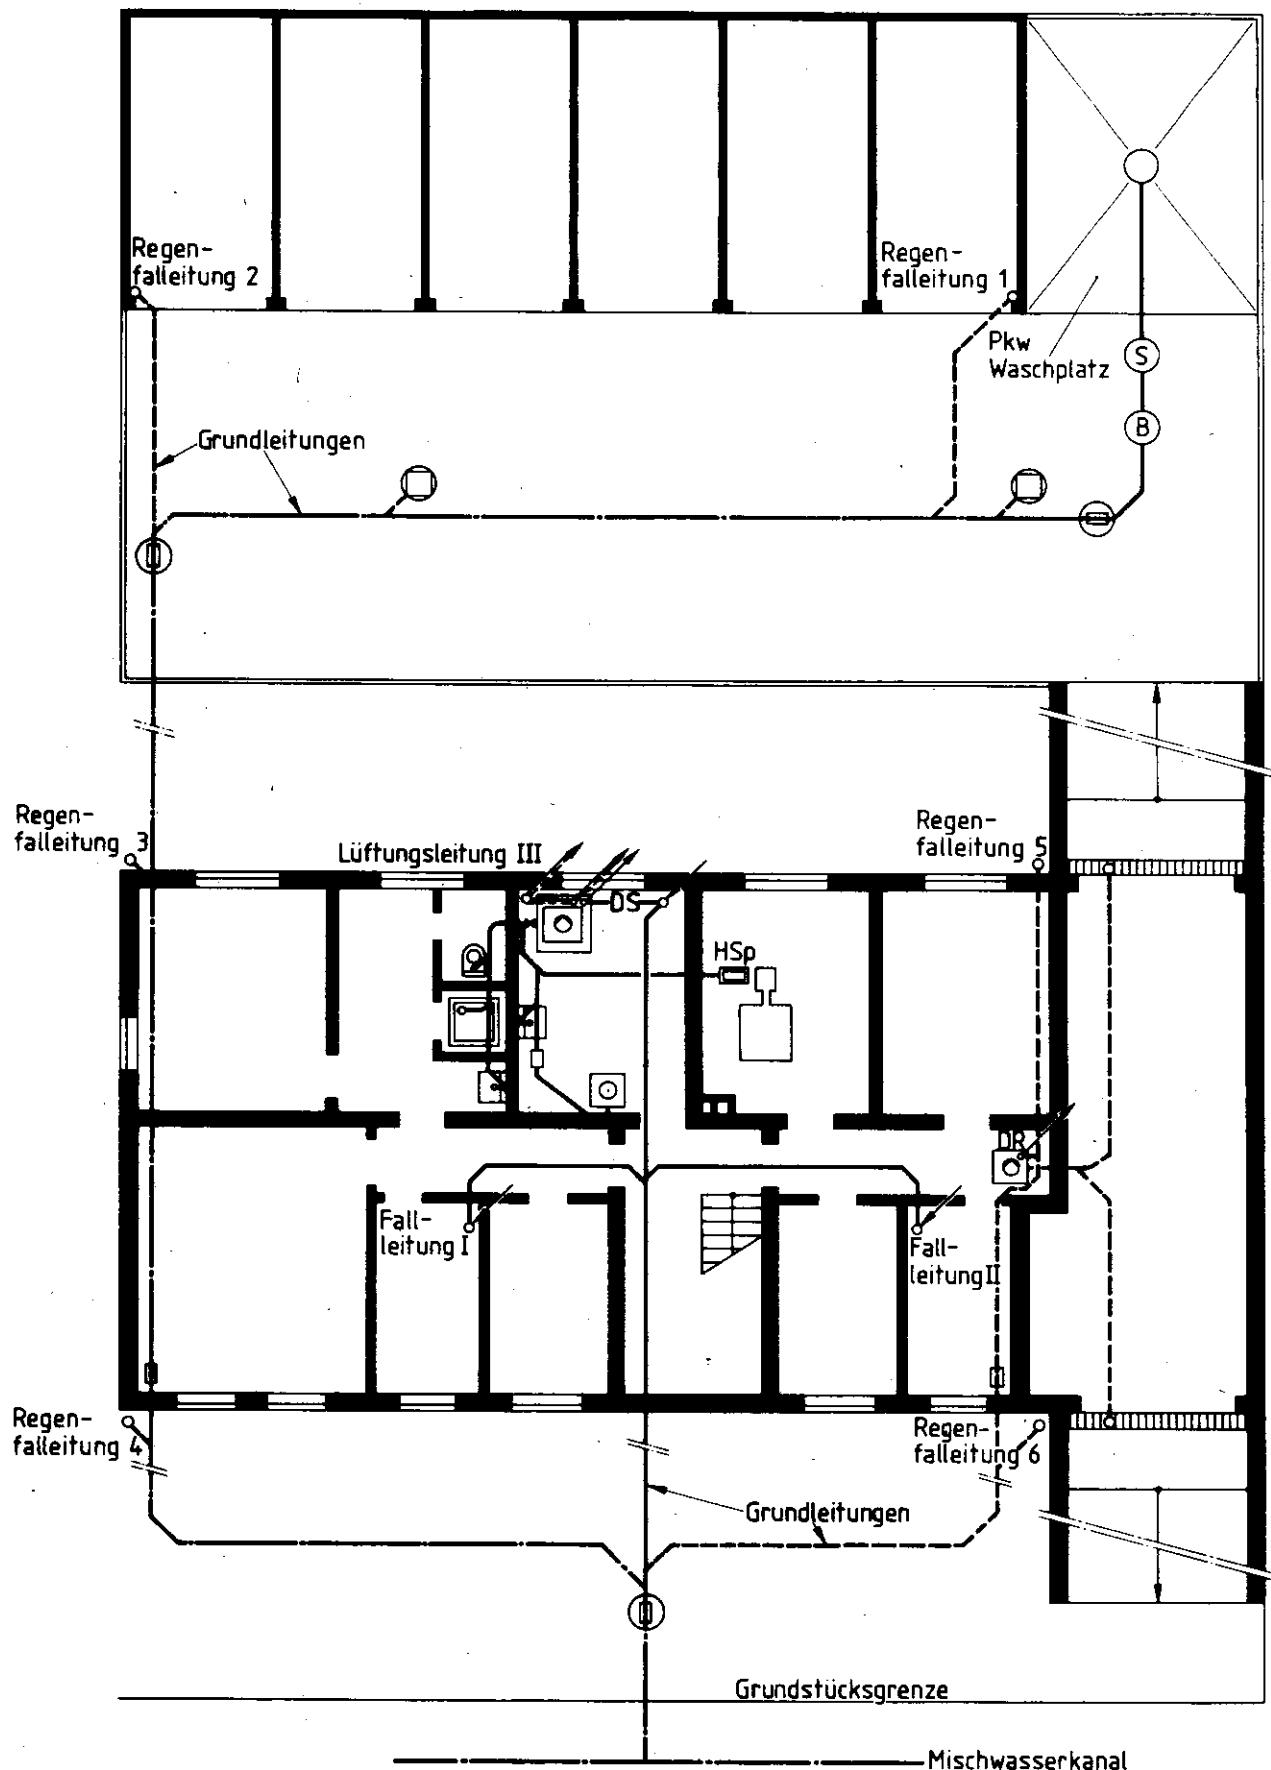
Kellergeschoß mit Grund- und Sammelleitungen sowie Abwasserhebebeanlagen beim Mischverfahren
